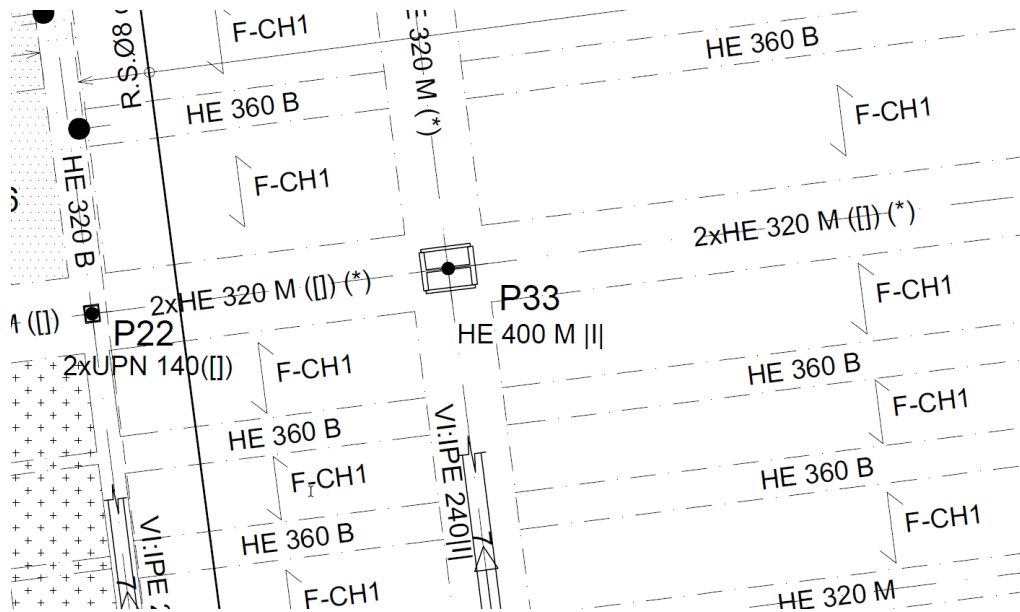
Zona de unión entre pilar P33 y dos vigas doble HEM320 soldadas en cajón.
